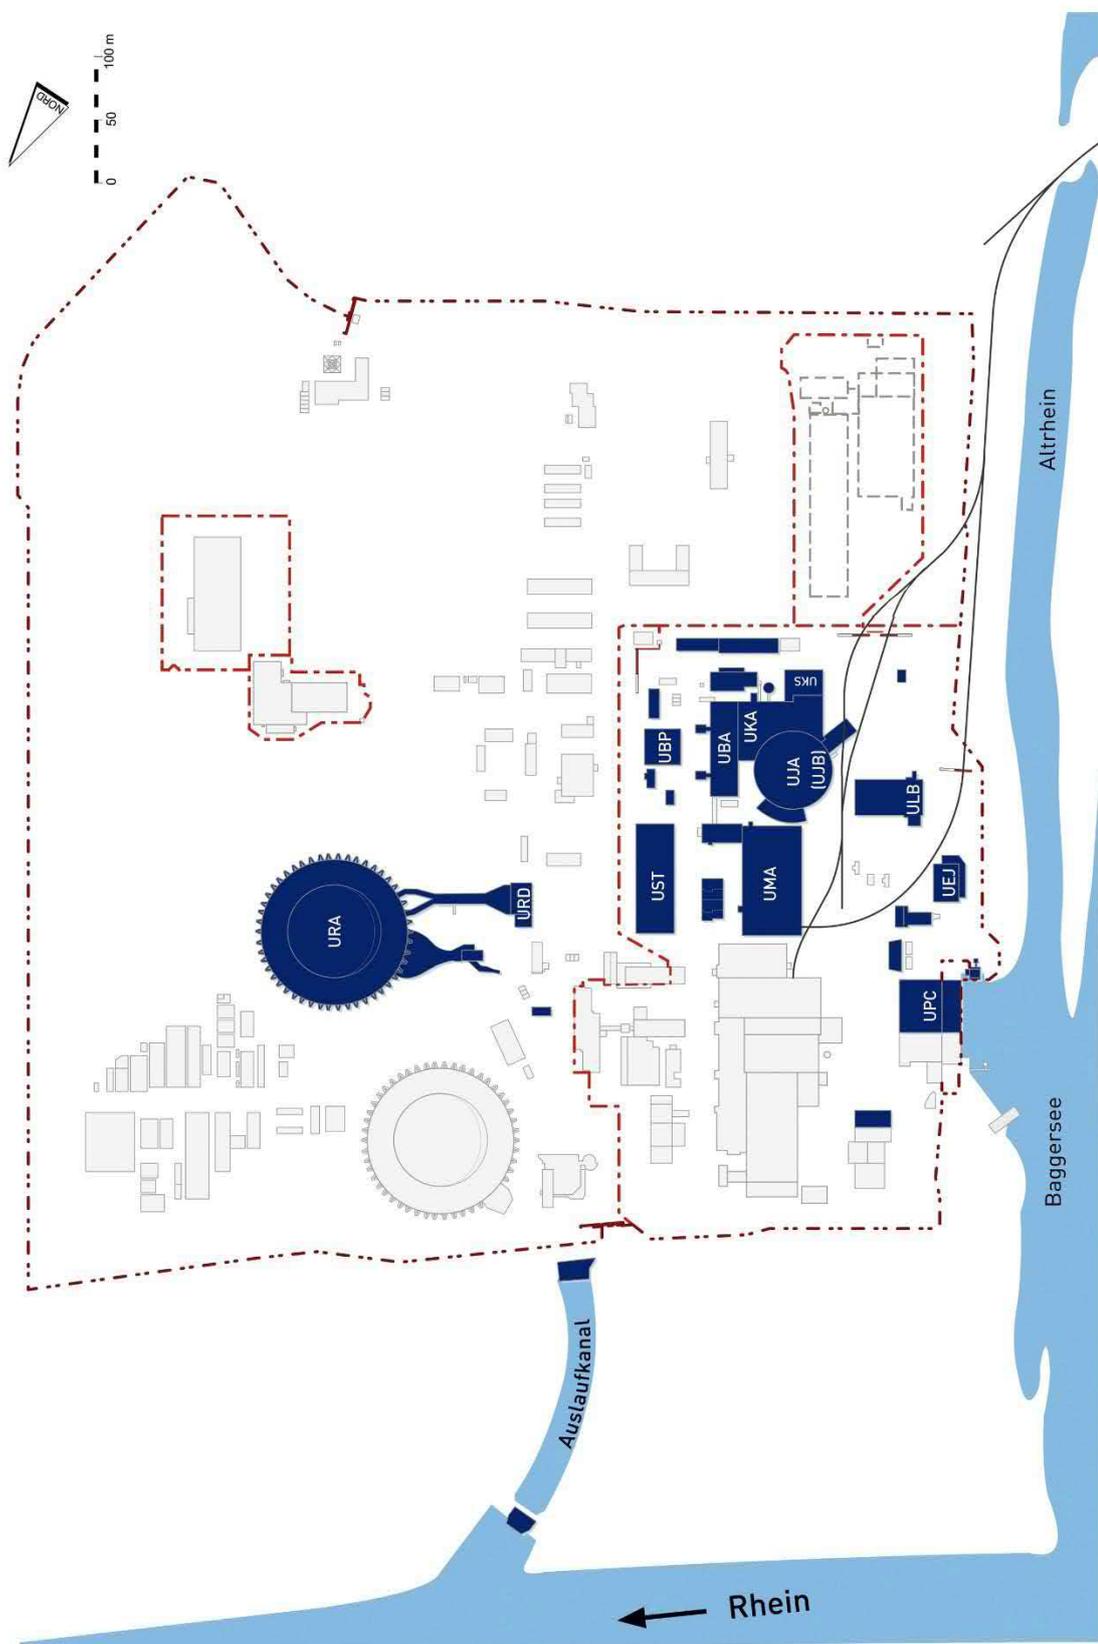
Lageplan des Kernkraftwerks Philippsburg
